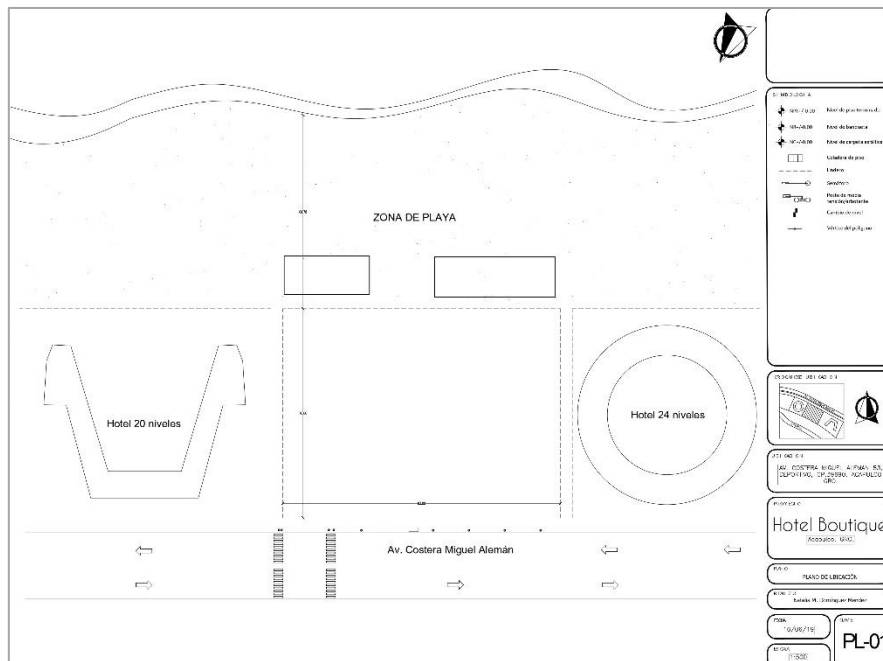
Plano de ubicación del terreno, Elaboración propia
